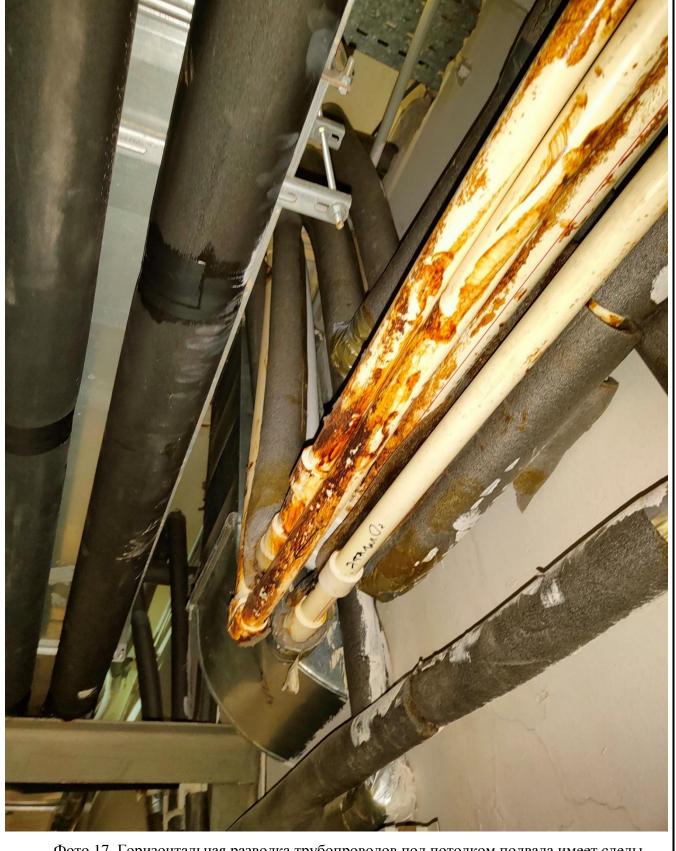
Горизонтальная разводка трубопроводов под потолком подвала имеет следы коррозии, даже на пластиковых трубопроводах.
